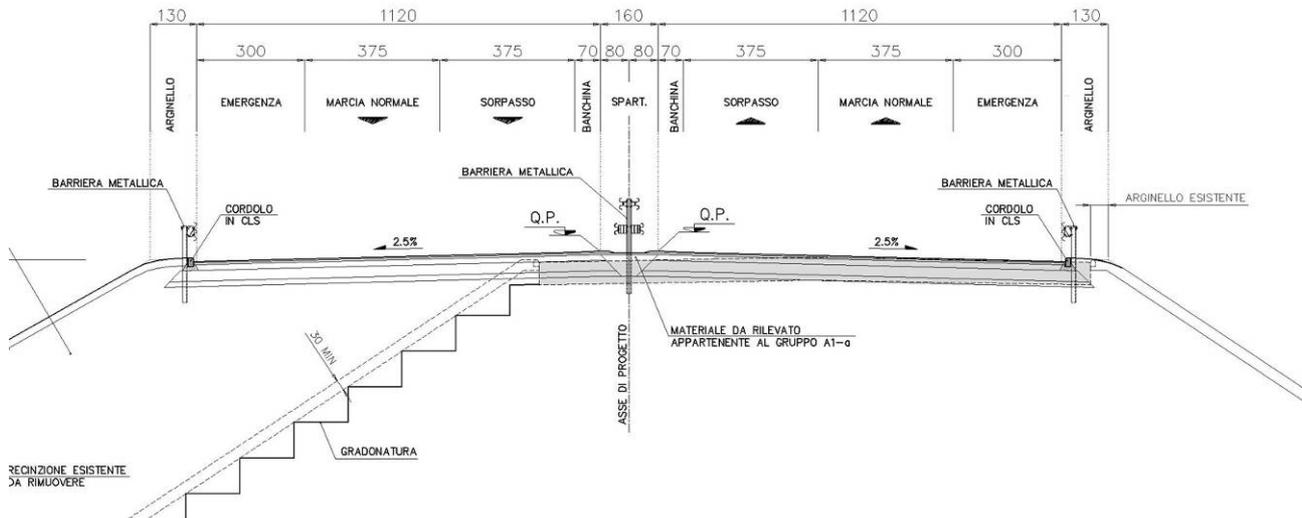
Sezione tipo di progetto (adeguamento asimmetrico SS1 Aurelia)
